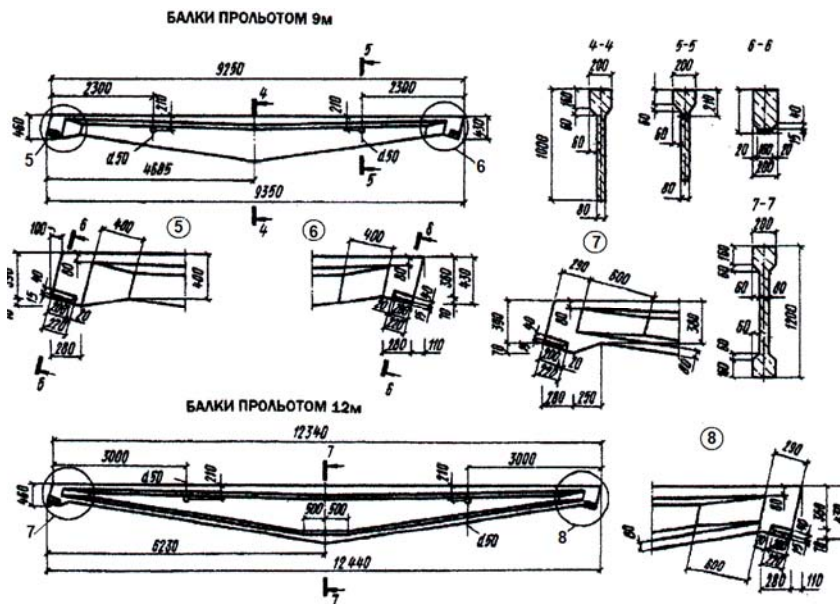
Залізобетонні попередньо напружені одностатні балки покриття
